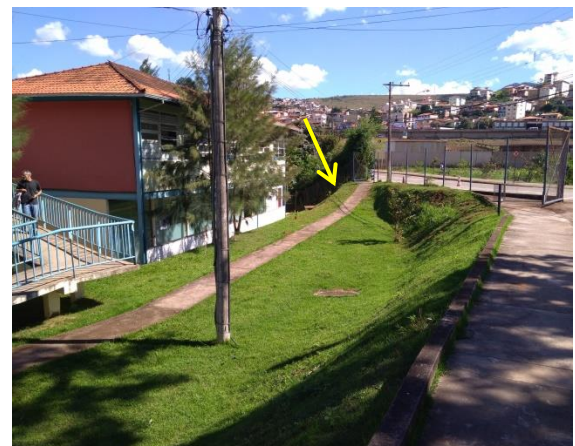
Caminho inclinado entre o acesso secundário e recepção. Fonte: Autor (2019).
